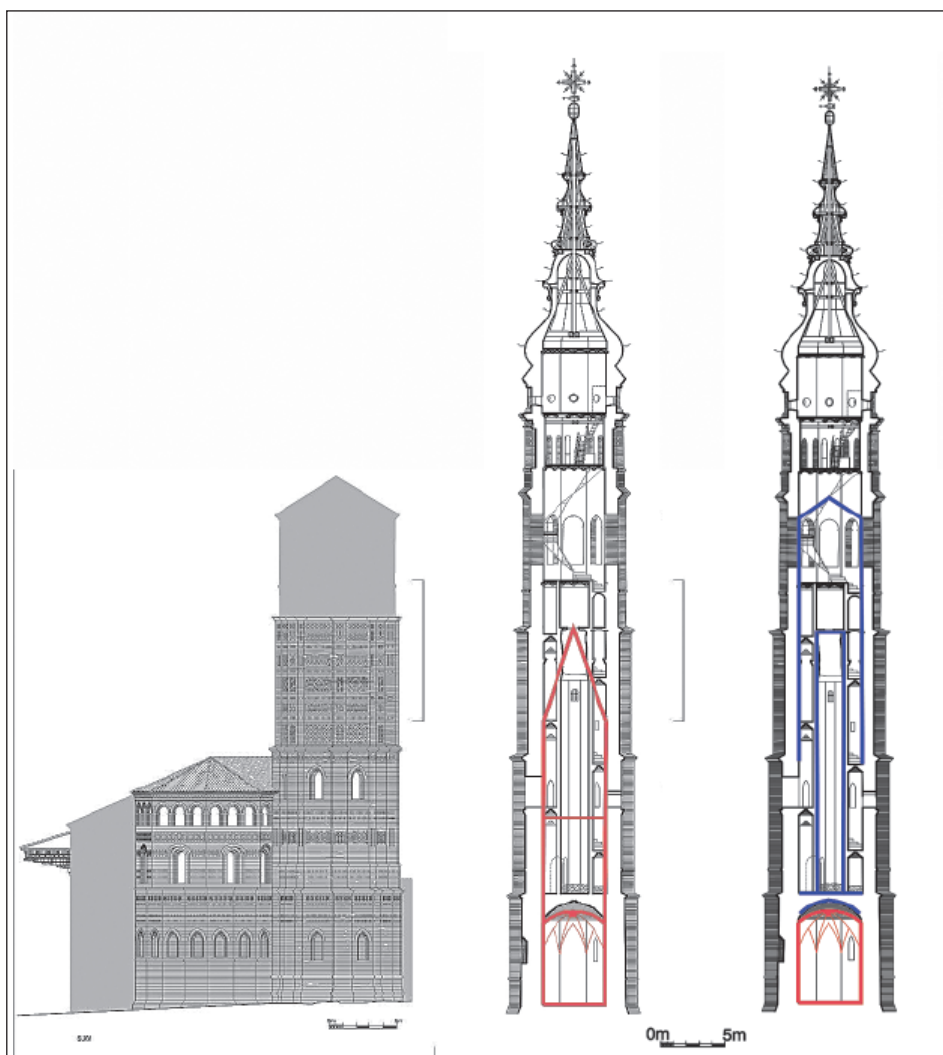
Posible secuencia constructiva, sobre la sección de la torre actual y junto al alzado correspondiente al siglo XVI, con esquema de las estructuras interiores que pudieron sucederse.
